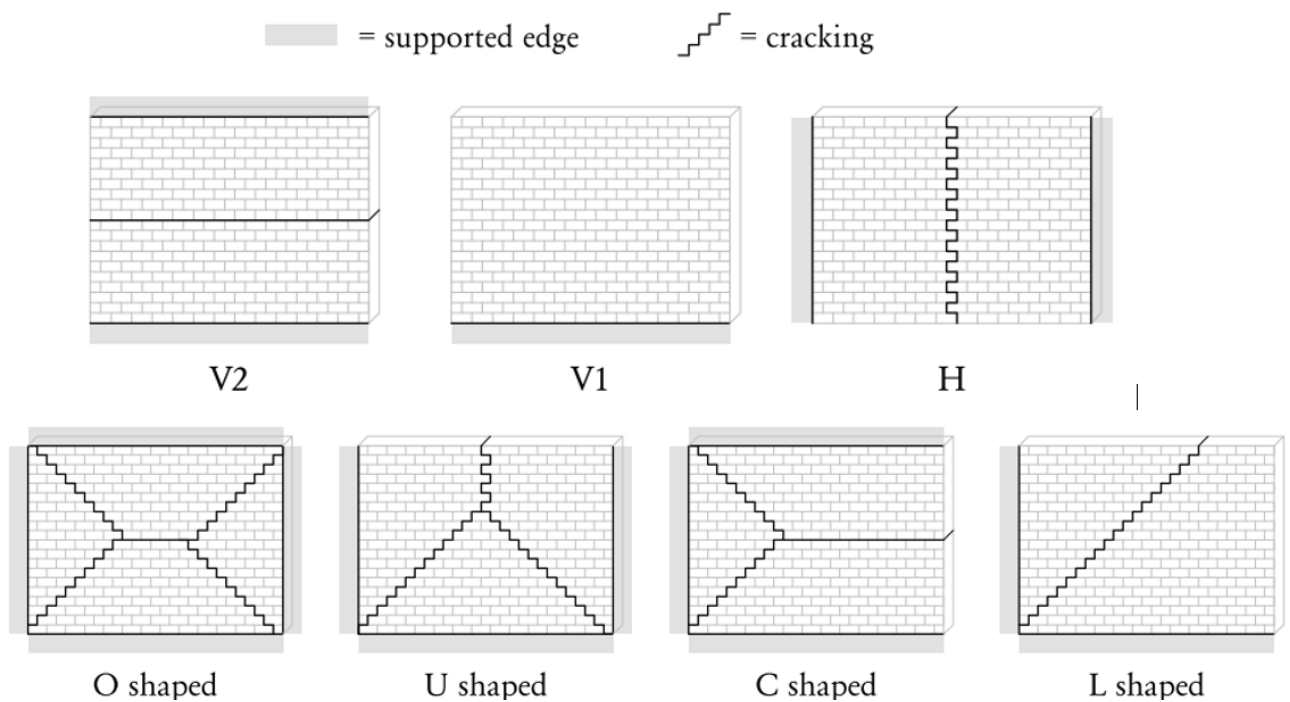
Tipos de soporte de muros y patrones de fisuración asociados a fallas fuera del plano (Vaculik, 2012)
